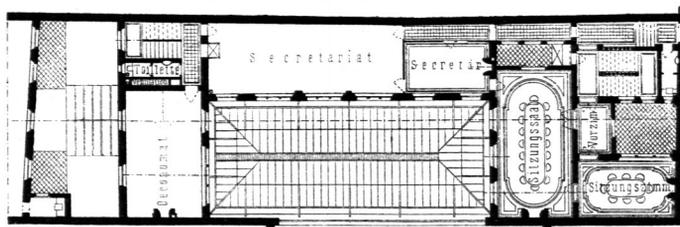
zeigt den Grundriß des Erdgeschoßs, dessen Haupttheil ein an drei Seiten
